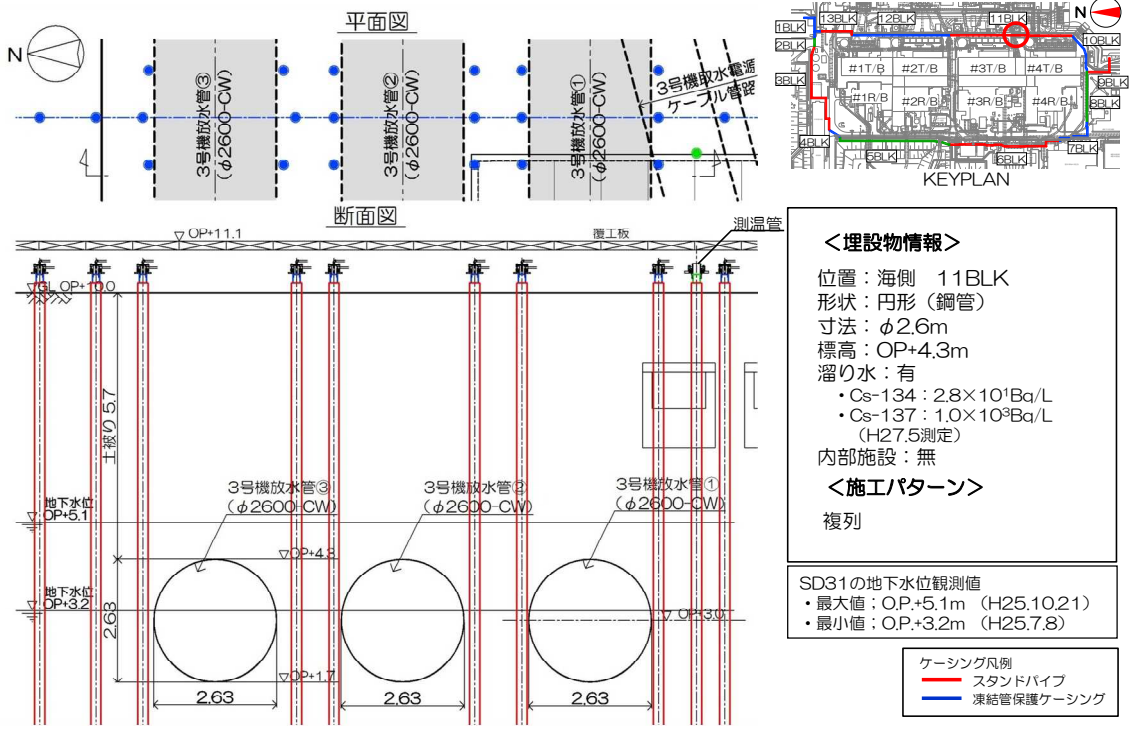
【11-9】3号機放水管①②③ 施工方法（複列施工）
